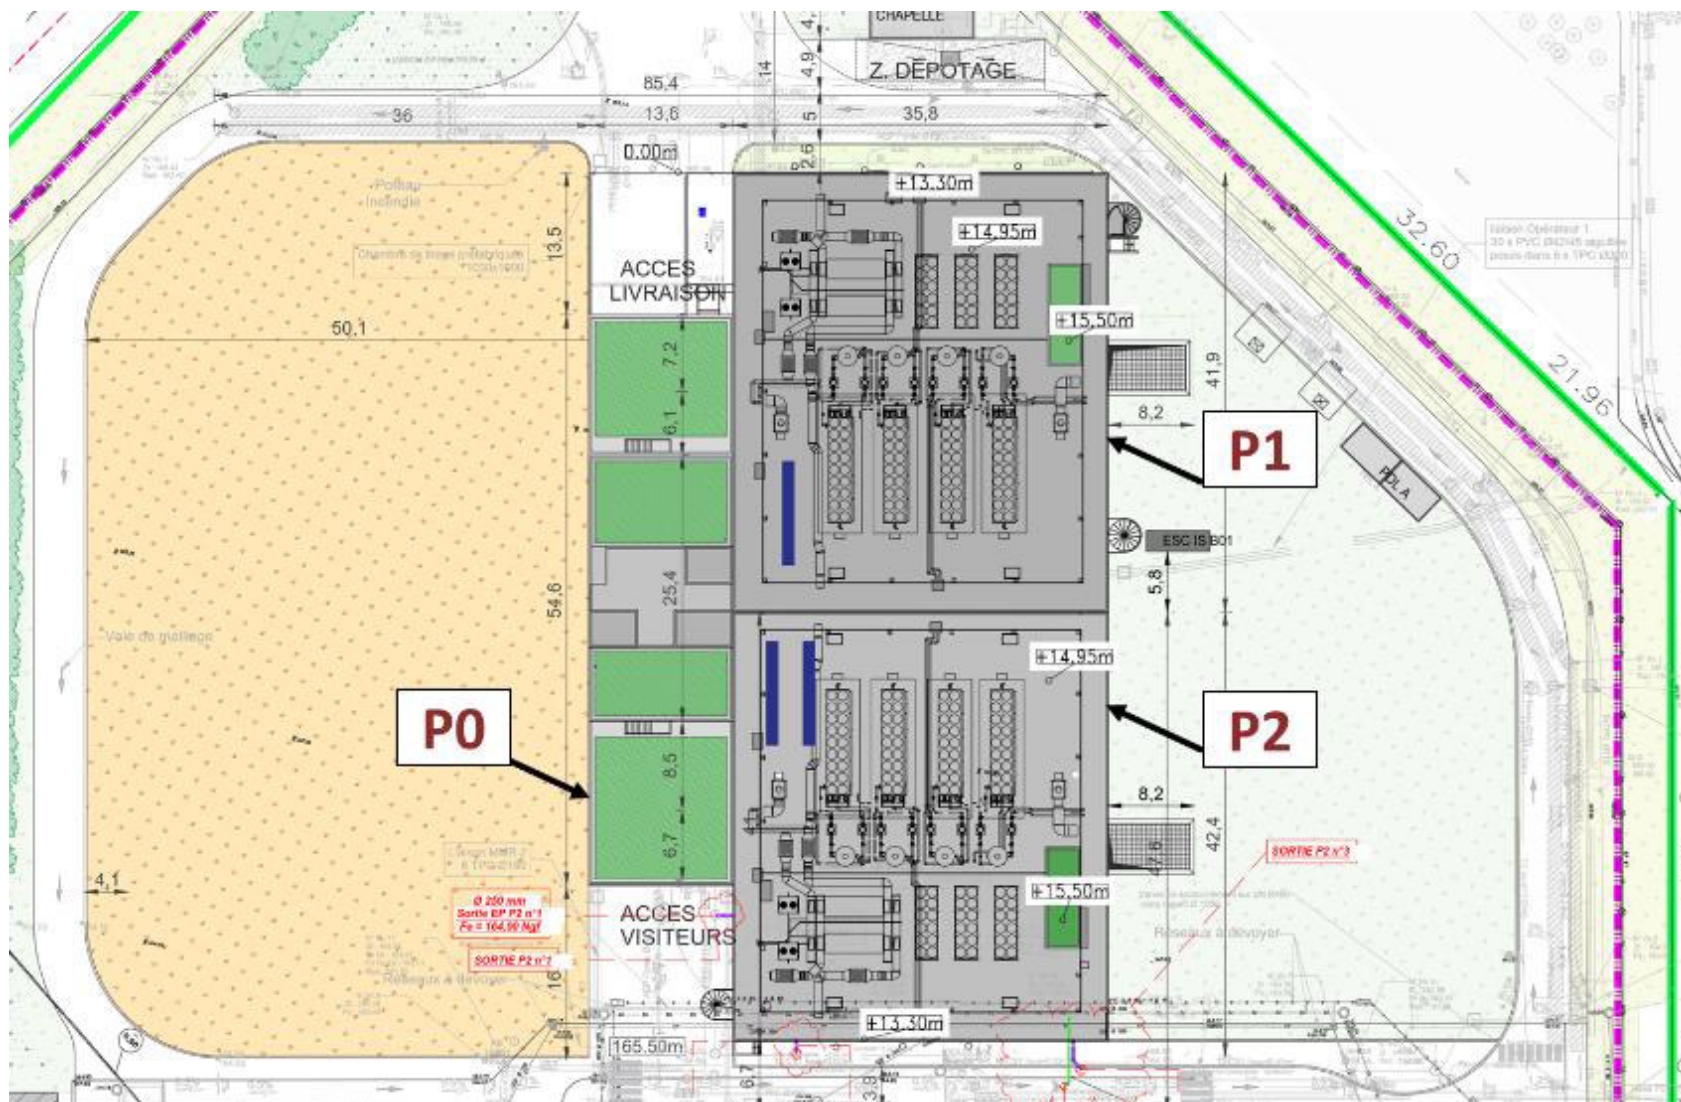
Plan de masse du site en vue rapprochée sur P2
